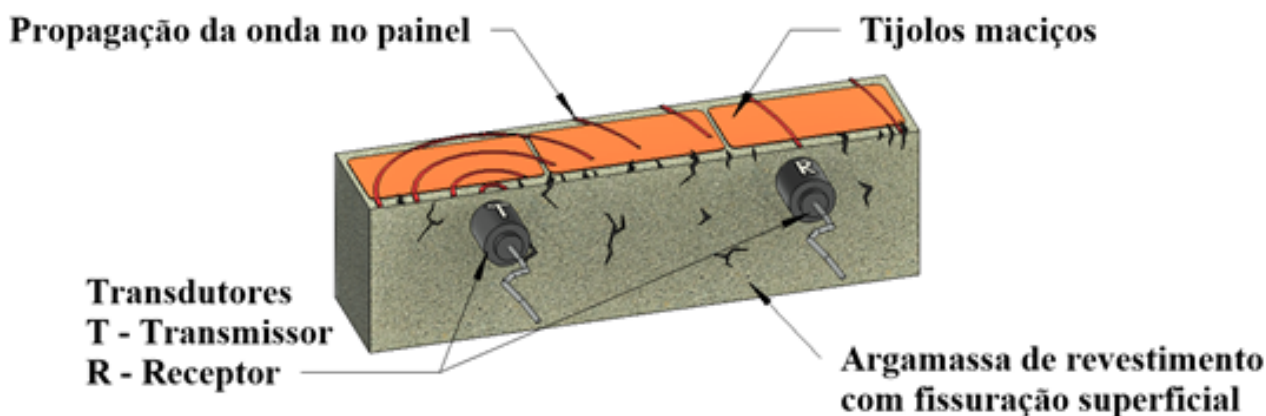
Propagação da onda em um painel com argamassa de revestimento fissurada.
